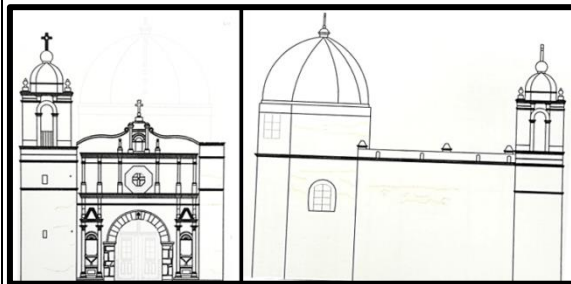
Fachadas de la Parroquia de Santa María de las Rosas. (Esquivel, 2016)
